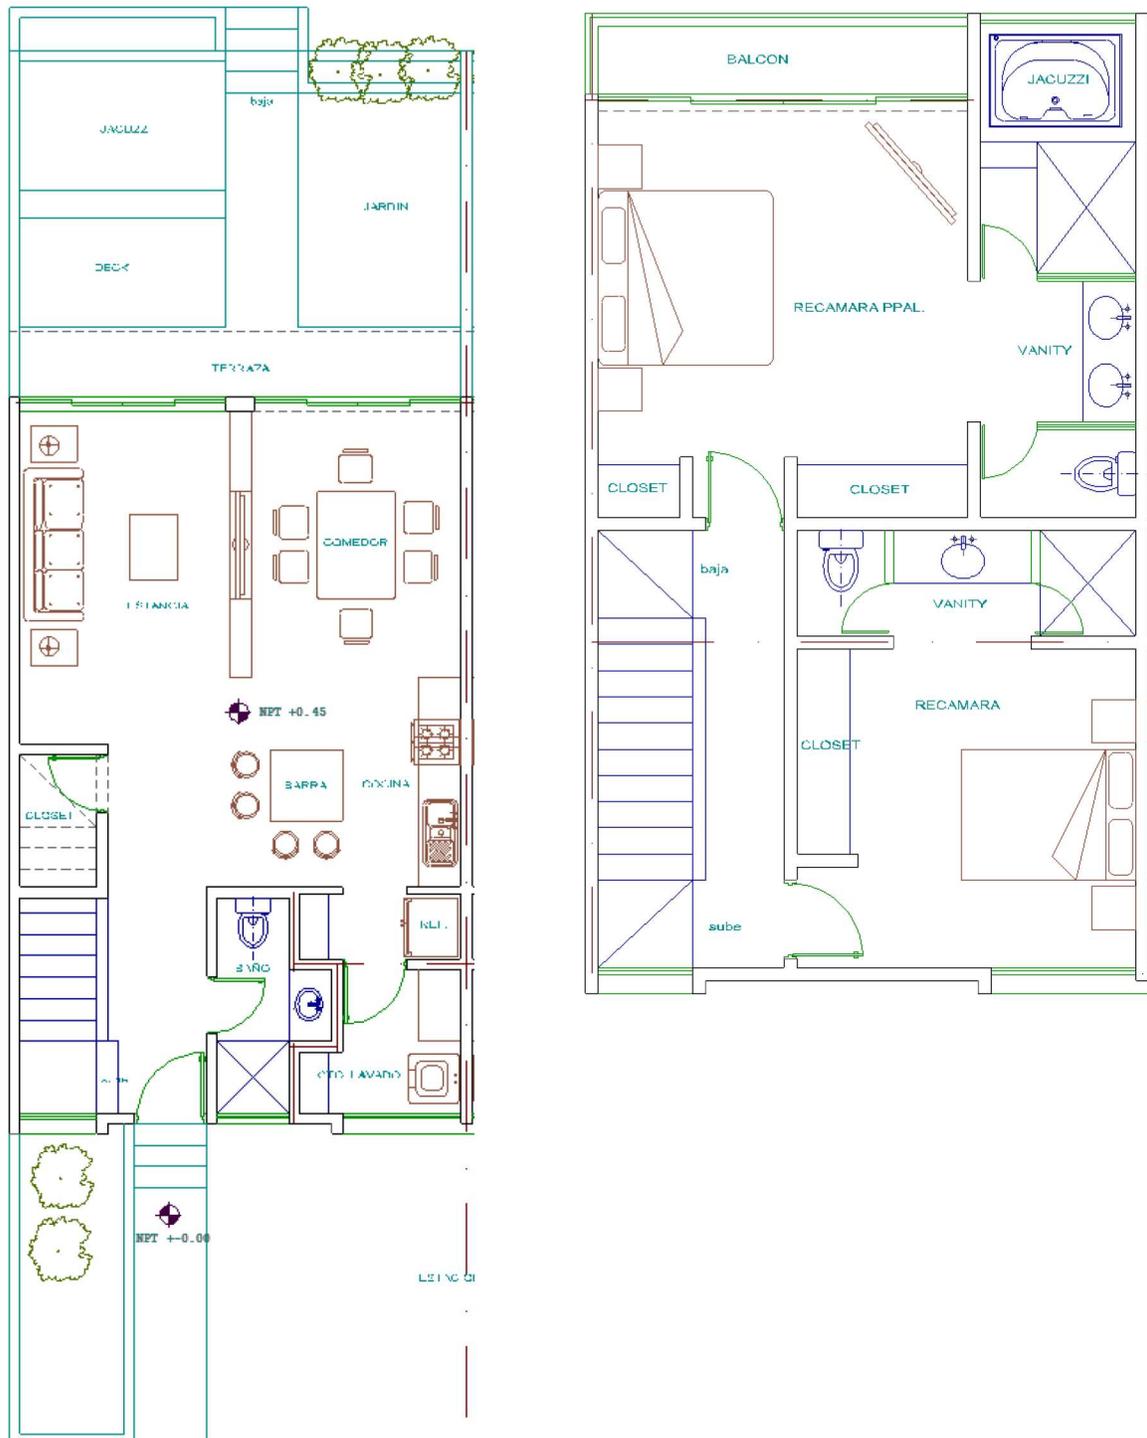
Planos arquitectónicos planta baja y primer nivel de las villas
